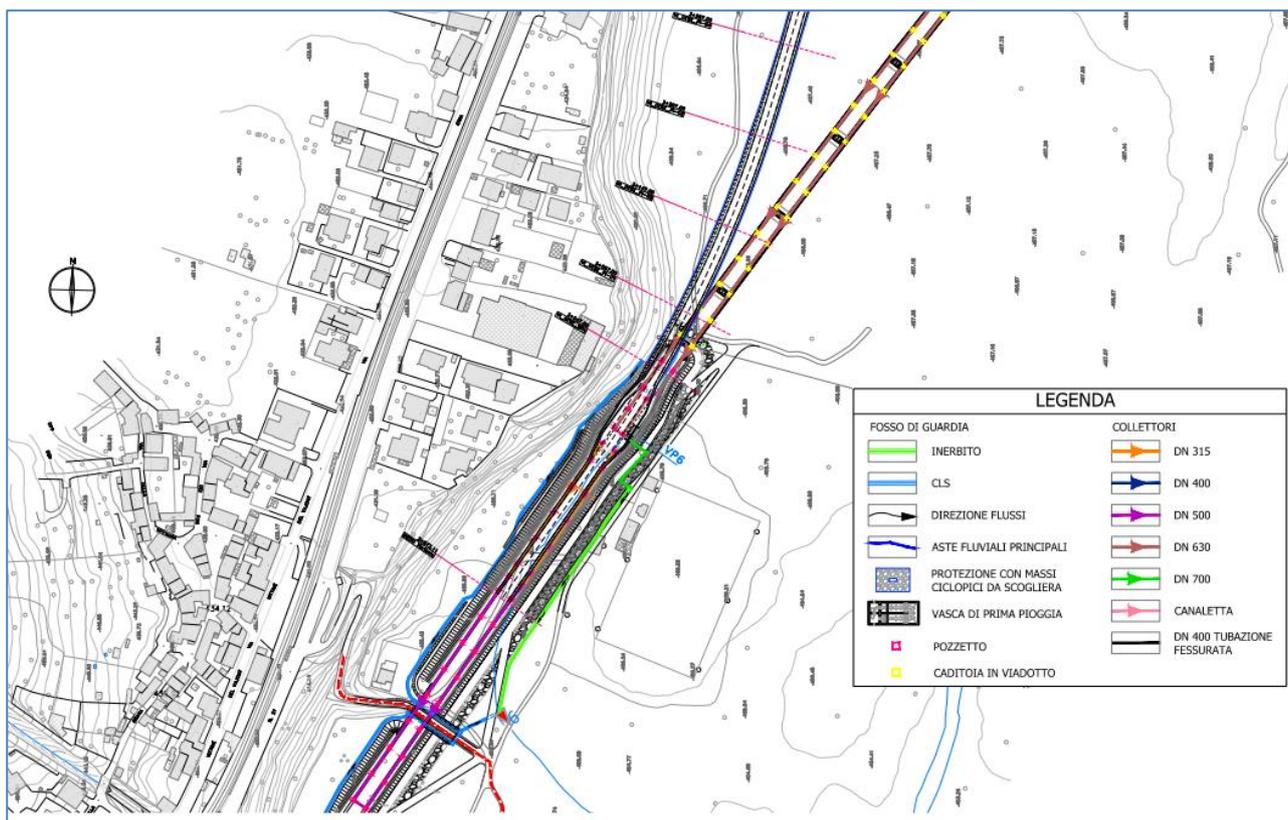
Stralcio planimetria idraulica della variante di progetto presso il Biotopo Risorgive del Piave
